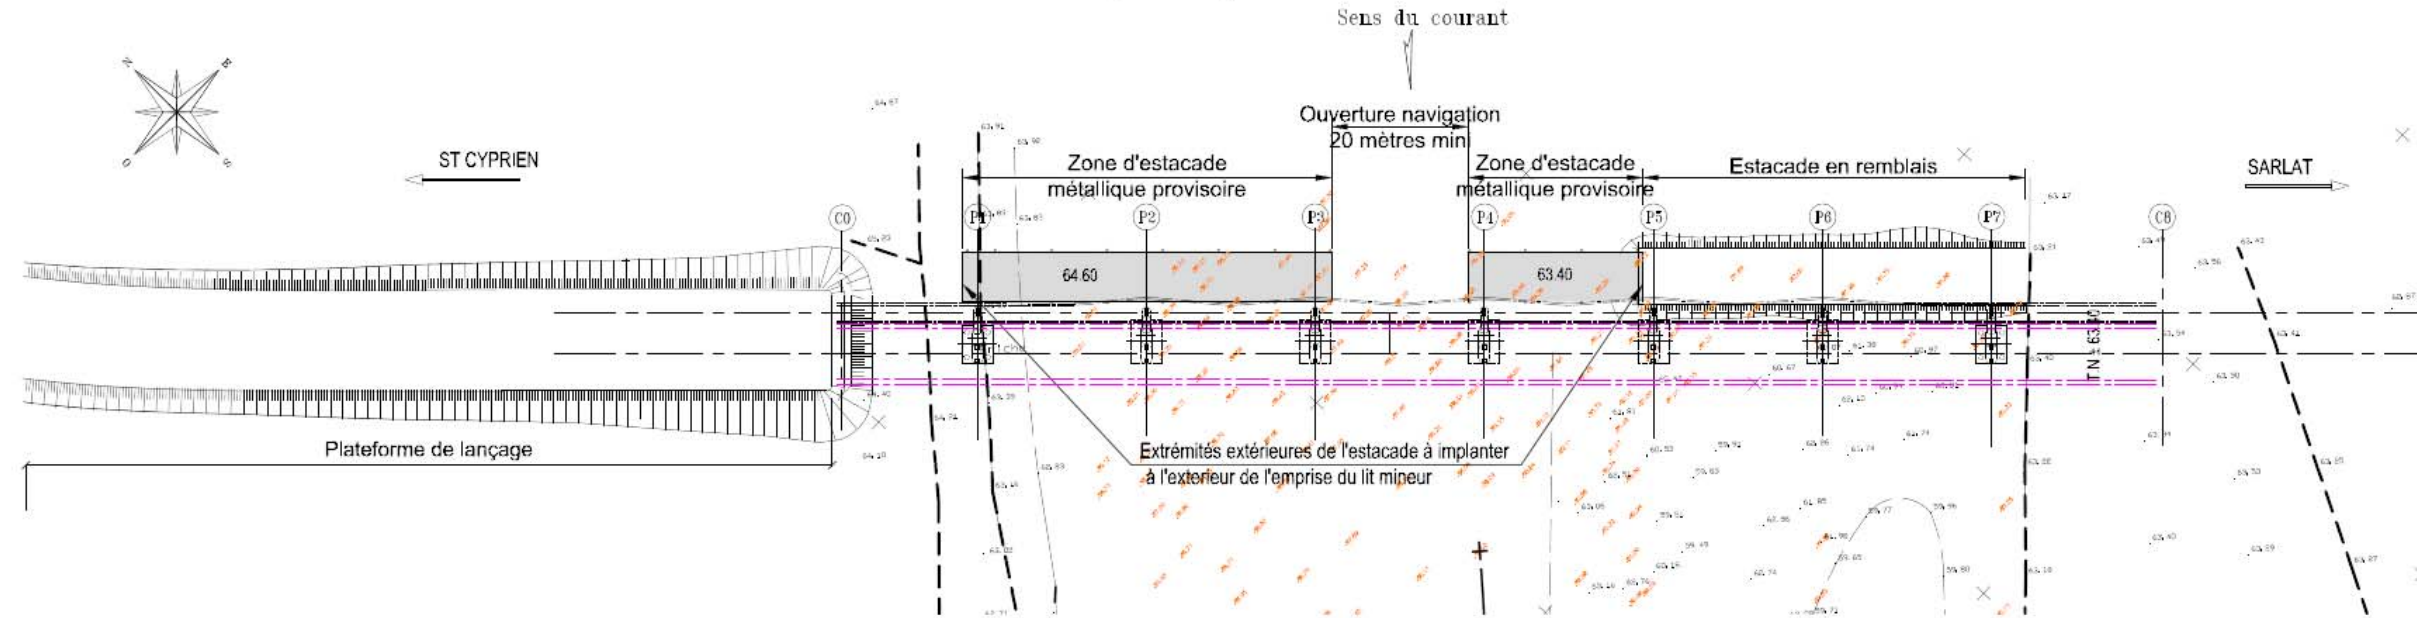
Vue en plan Pont du Pech – Phase travaux (Source : setec tpi, avril 2017)
